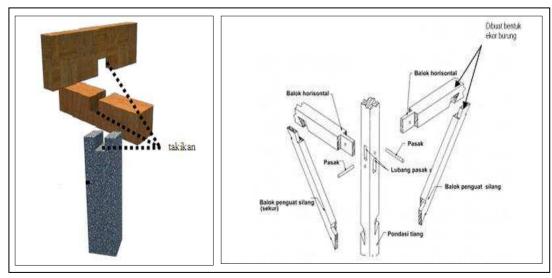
Balok Pengaku Pada Pondasi Umpak
